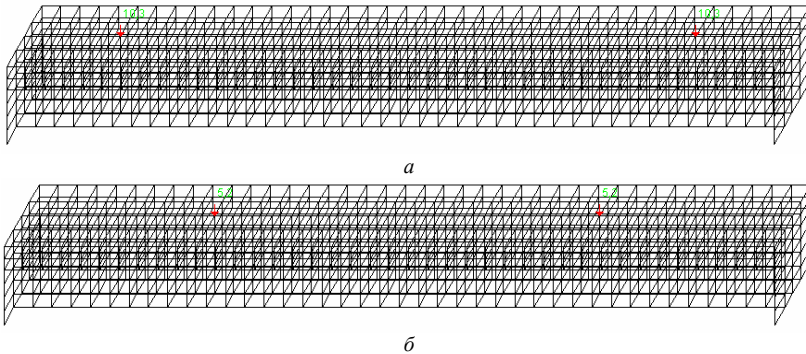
Розрахункові схеми балок з прикладеним навантаженням:
